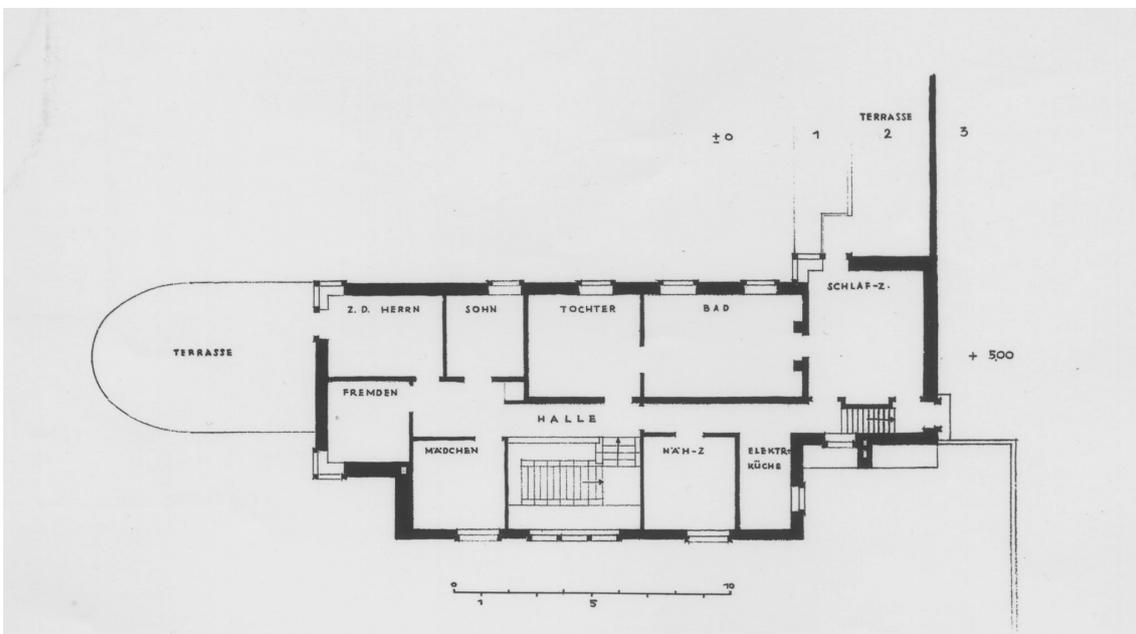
Grundriss erstes Obergeschoss, Publikationsplan, ohne Datum (1924)
